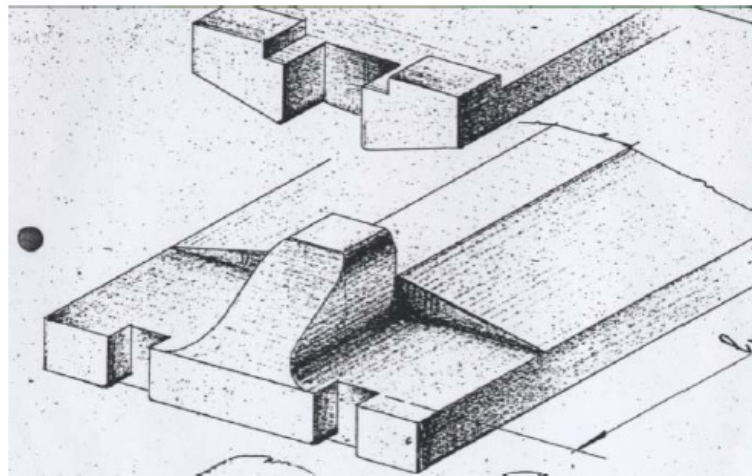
"Dispositivo di appoggio oscillante a contatto lineare"
